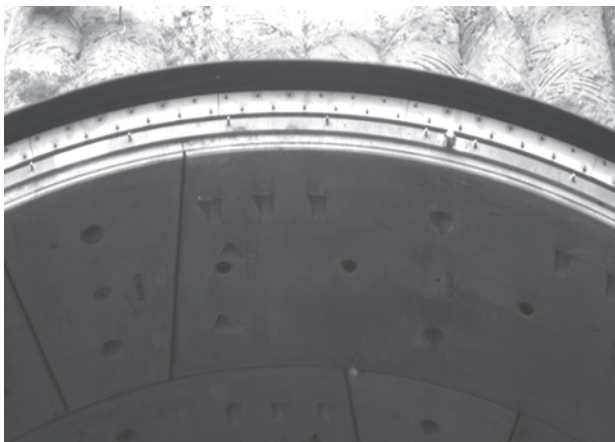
Flanschkonstruktion am Übergang zur Ortbetonbauweise, Bsp. Katzenbergtunnel
